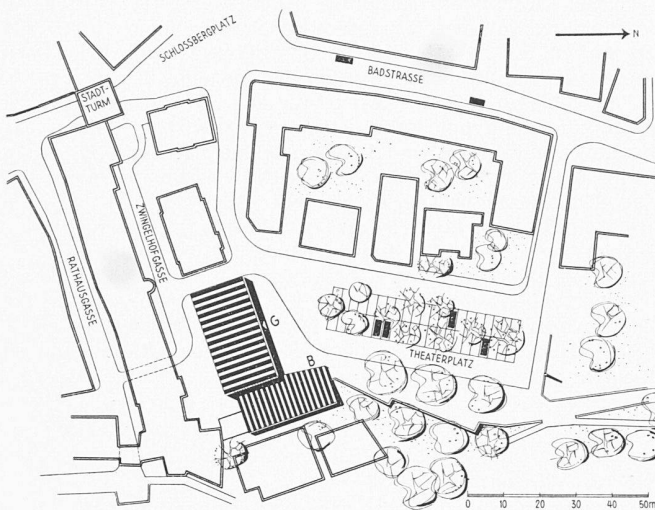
Lageplan, Masstab 1:2000. G bezeichnet das hier dargestellte Geschäftshaus, B das zukünftige Bezirksgebäude
